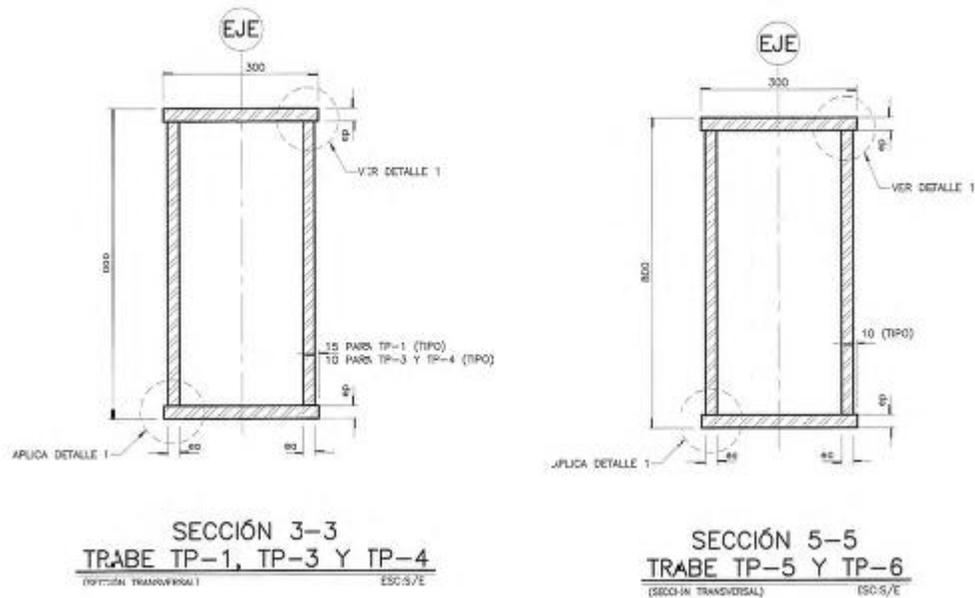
Sección de traves principales longitudinales y transversales tipo cajón, TP-1, TP-3, TP-4, TP-5 y TP-6.
